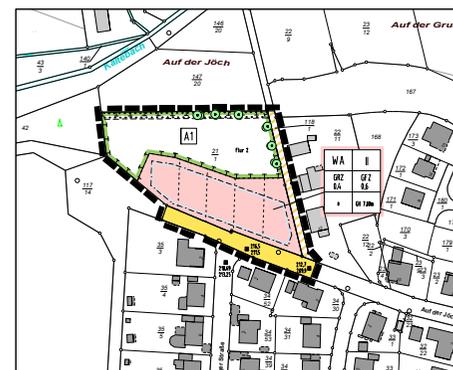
Planzeichnung der BPL-Änderung mit Geltungsbereich und Begrenzung der unterschiedlichen Nutzungsarten und Festsetzungen
